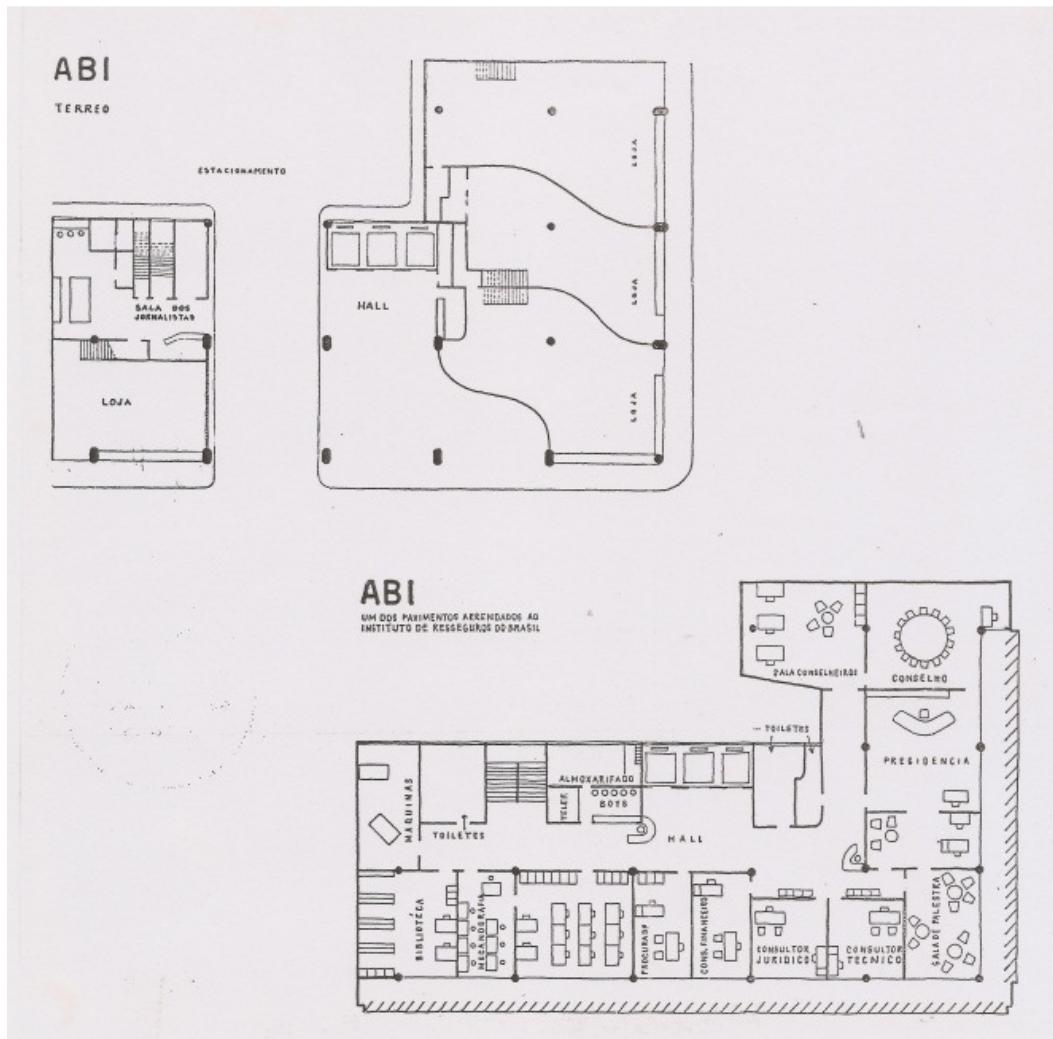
F – Plantas baixas pavimento térreo e dos pavimentos destinados à locação
